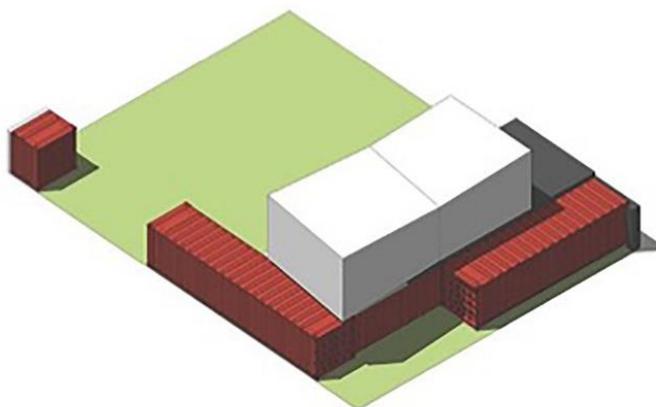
Maquete eletrônica - piso inferior - Casa José Schreiber Arquitecto.
